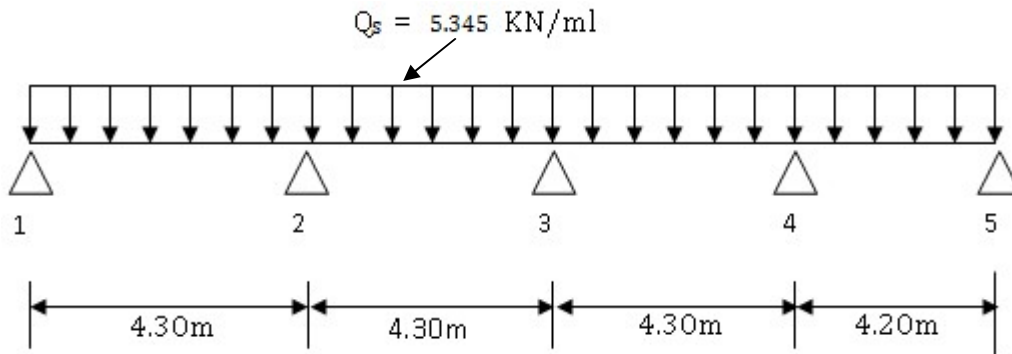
Schéma statique de la poutrelle type I à l'ELS.
